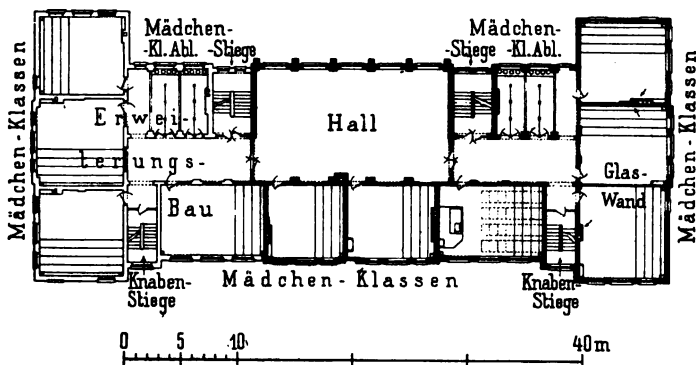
Grundriß des ersten Stockwerkes einer 20 klassigen Londoner Volksschule.
